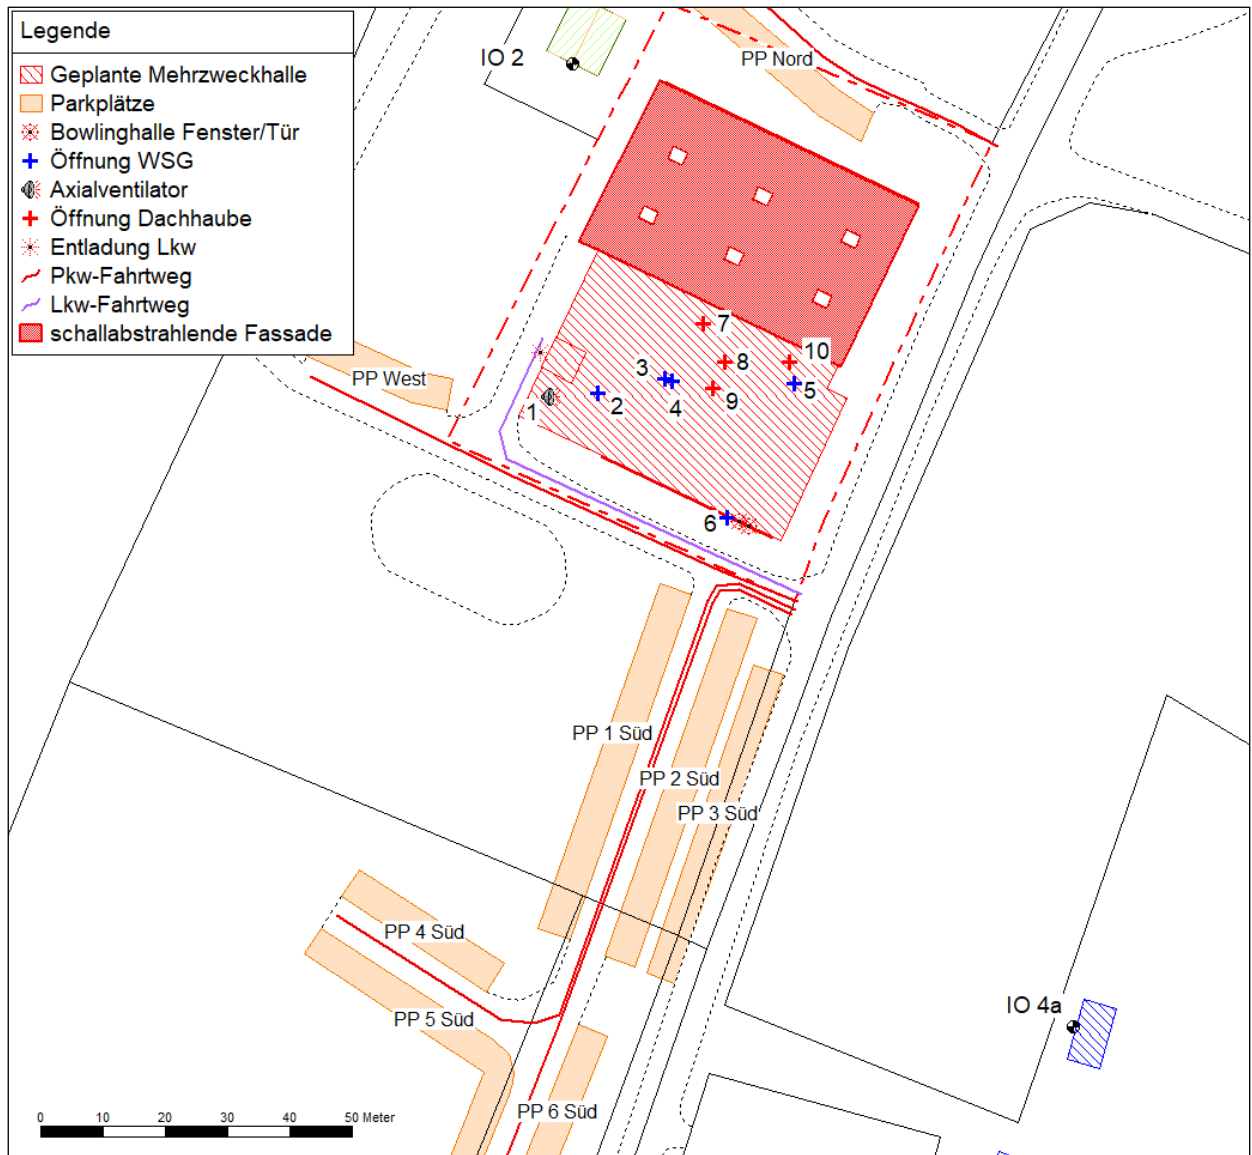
Lageplan-Ausschnitt des Rechenmodells mit Schallquellen (TGA mit Nummerierung gemäß Tabelle 6)
